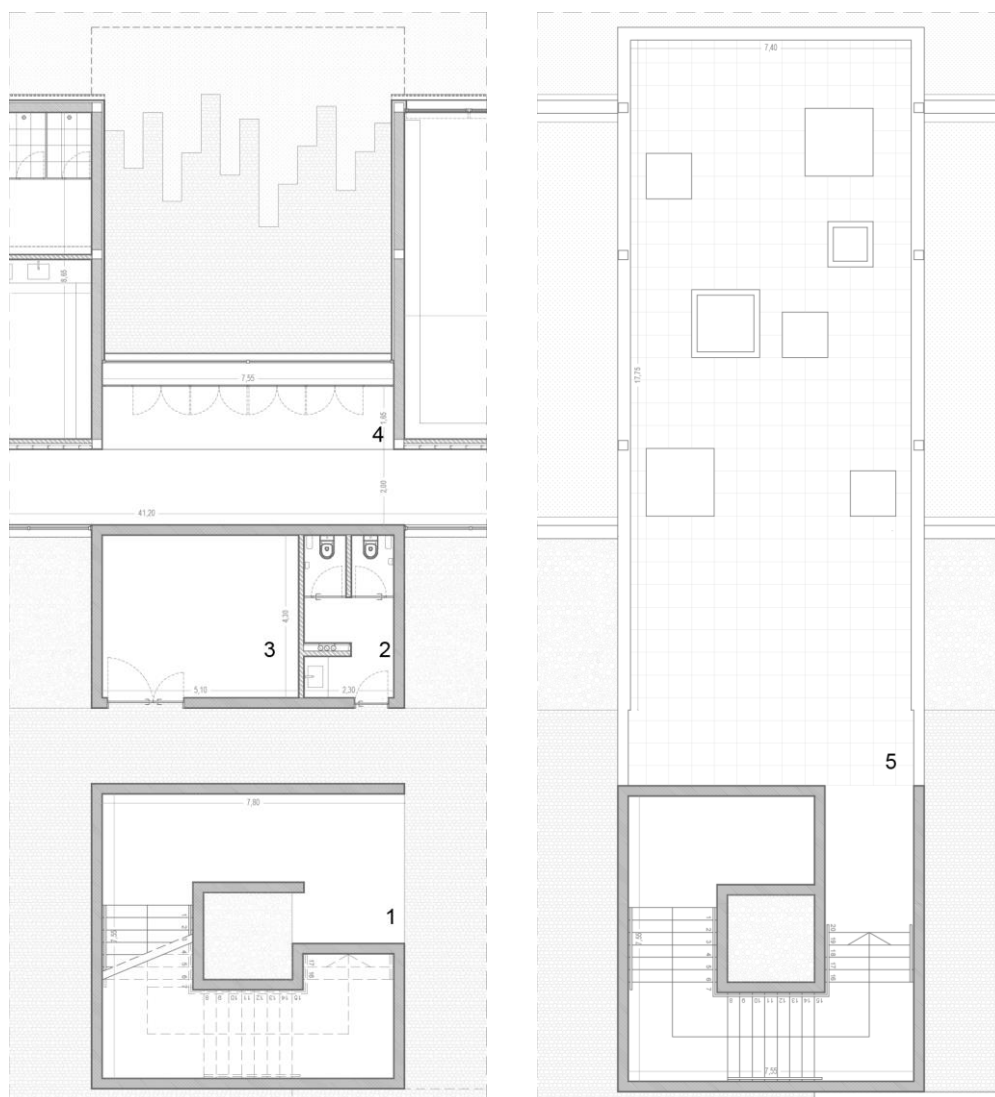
Planta pormenorizada da zona do miradouro, respetivamente piso 0 e piso 1.
